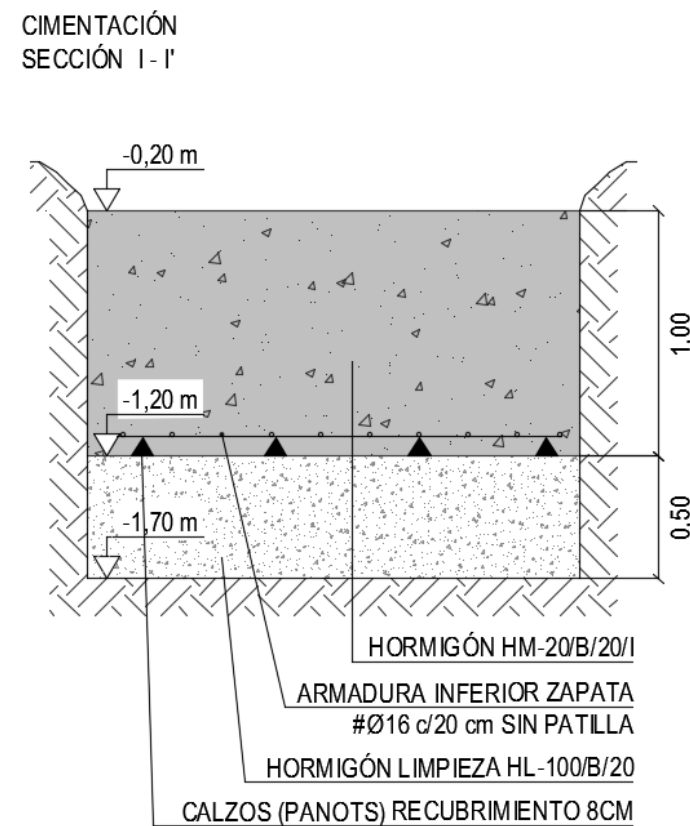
Sección detalle I-I' (CIMENTACIÓN)
